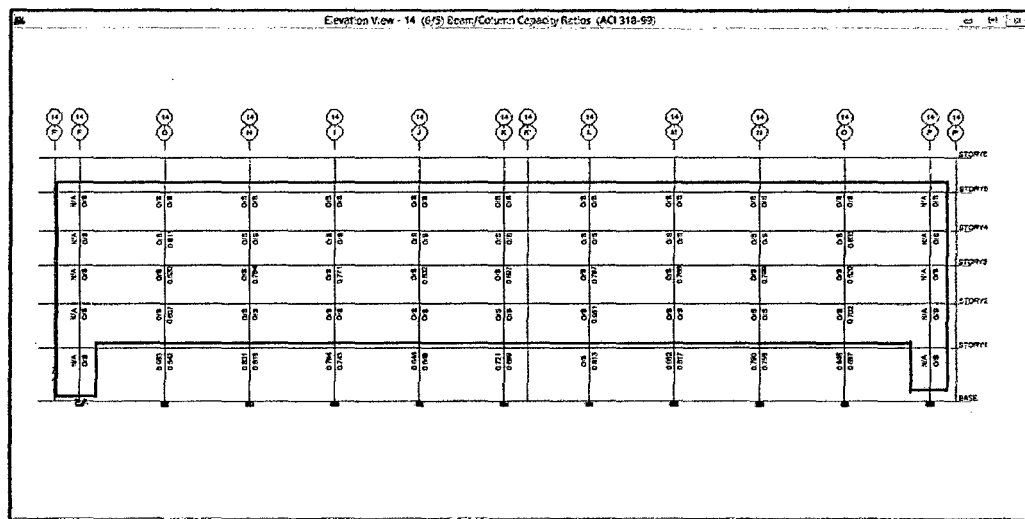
Ubicación de Fallas en columnas – Eje 14
